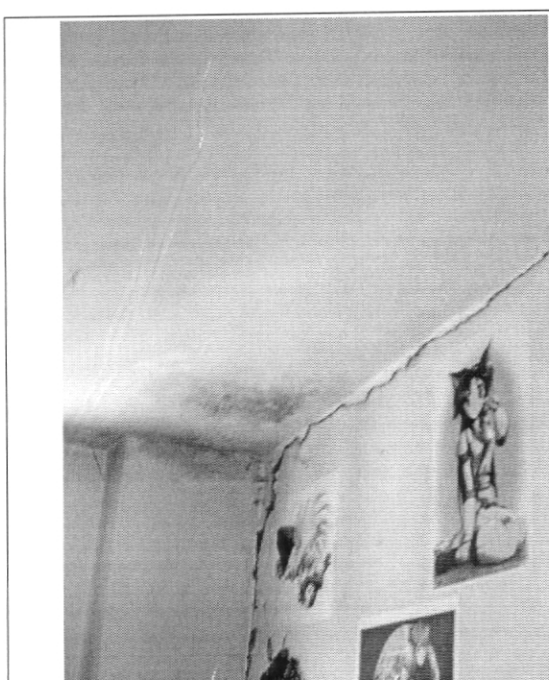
Fisura entre el muro y la placa de entripiso
